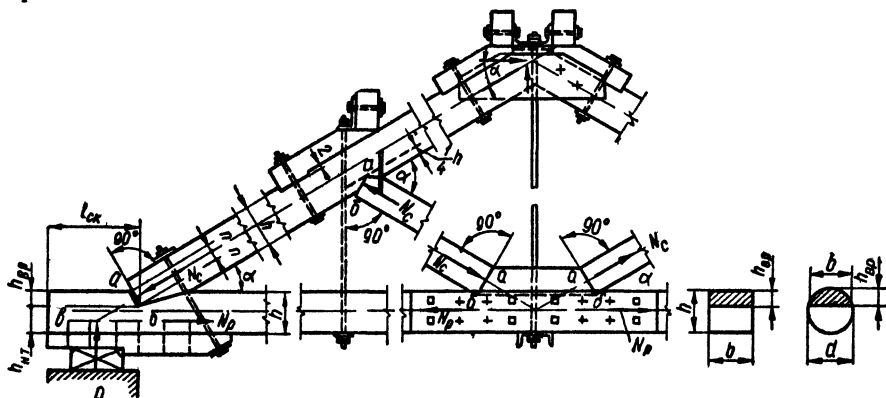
Схема фермы, опорный узел которой решен на лобовой врубке с одним зубом.
